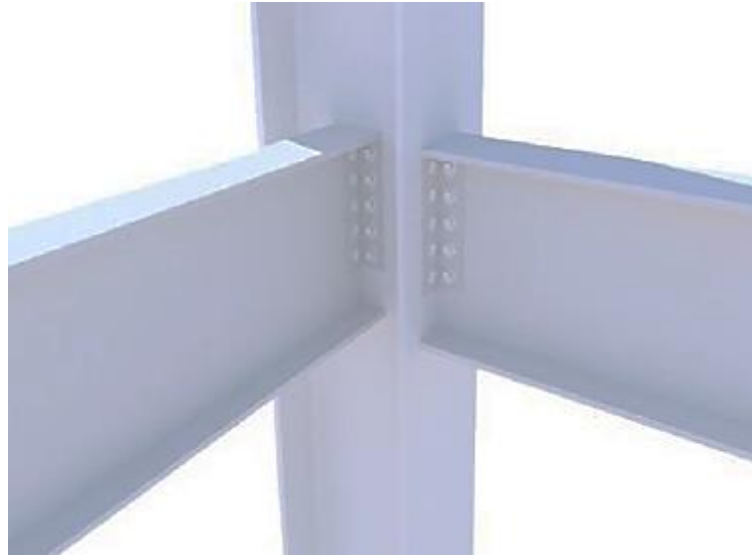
Dupla Cantoneira de Alma em conexões pilar-viga
